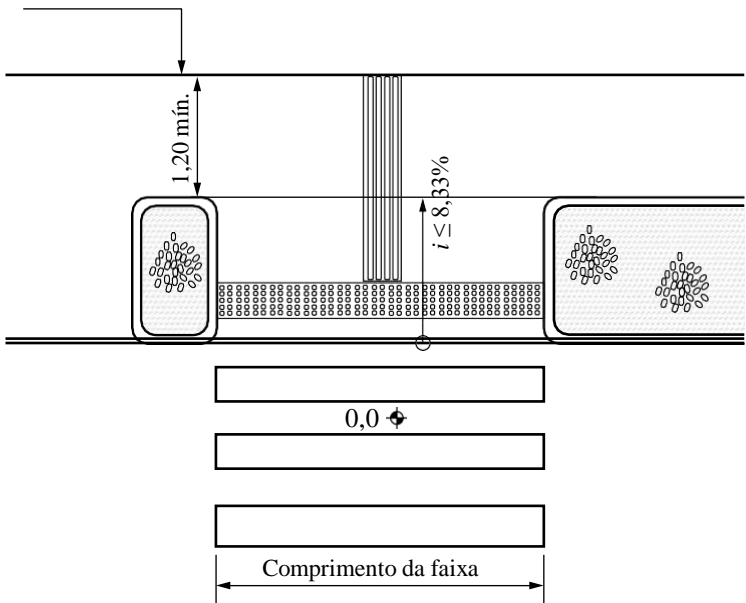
Rebaixamentos de calçada entre canteiros – Vista superior
